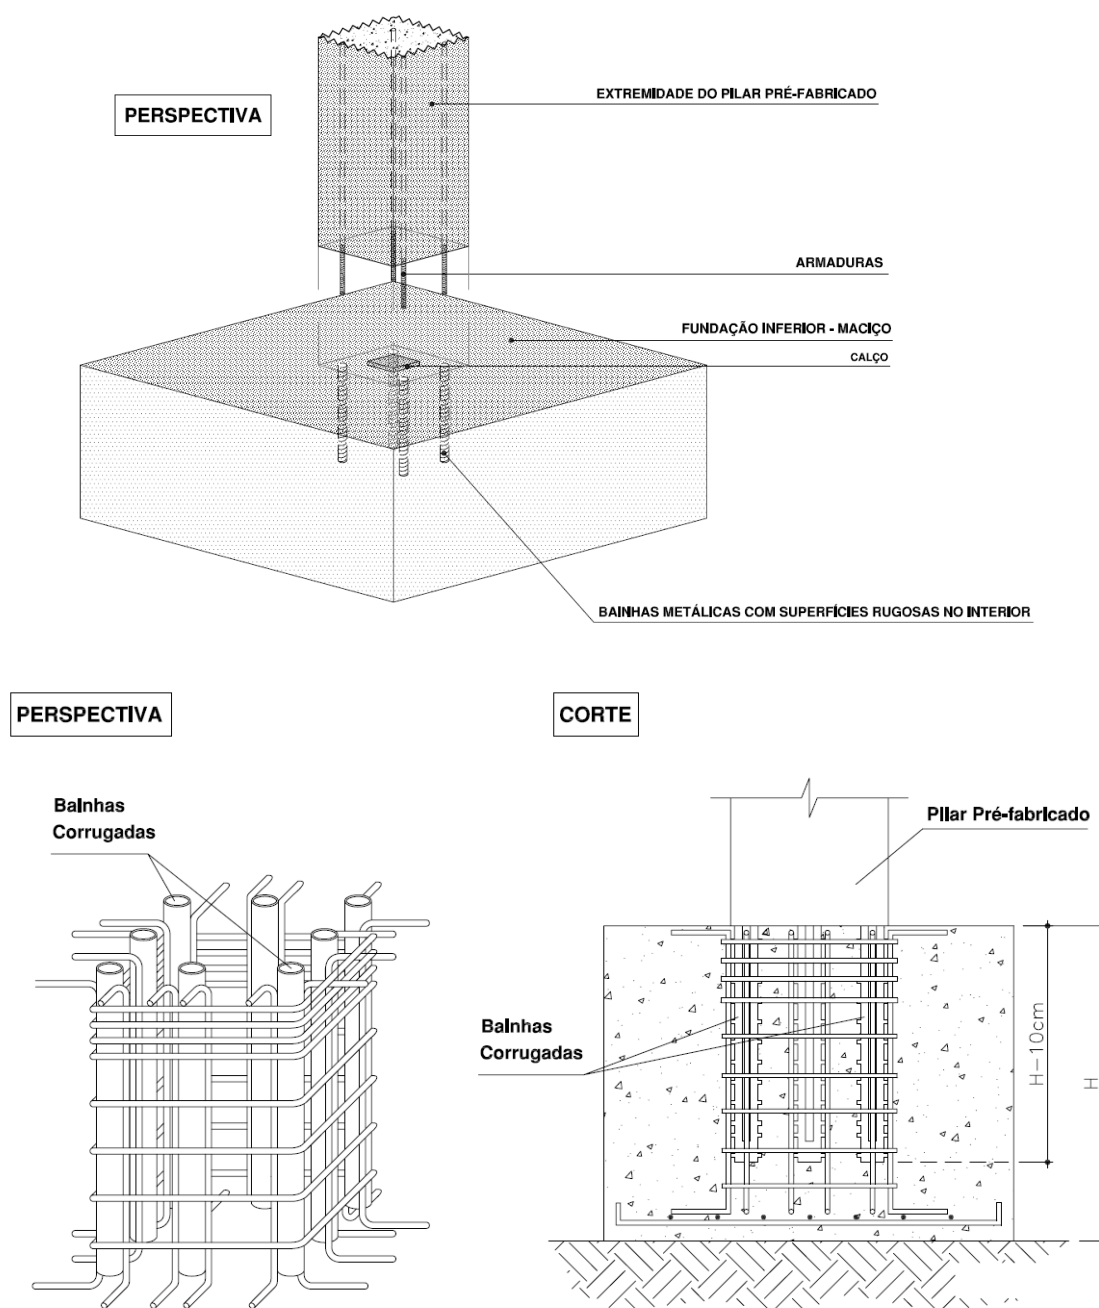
Ligação pilar – fundação com Armaduras salientes do pilar (retirado de (REGUENGO, 2010))
